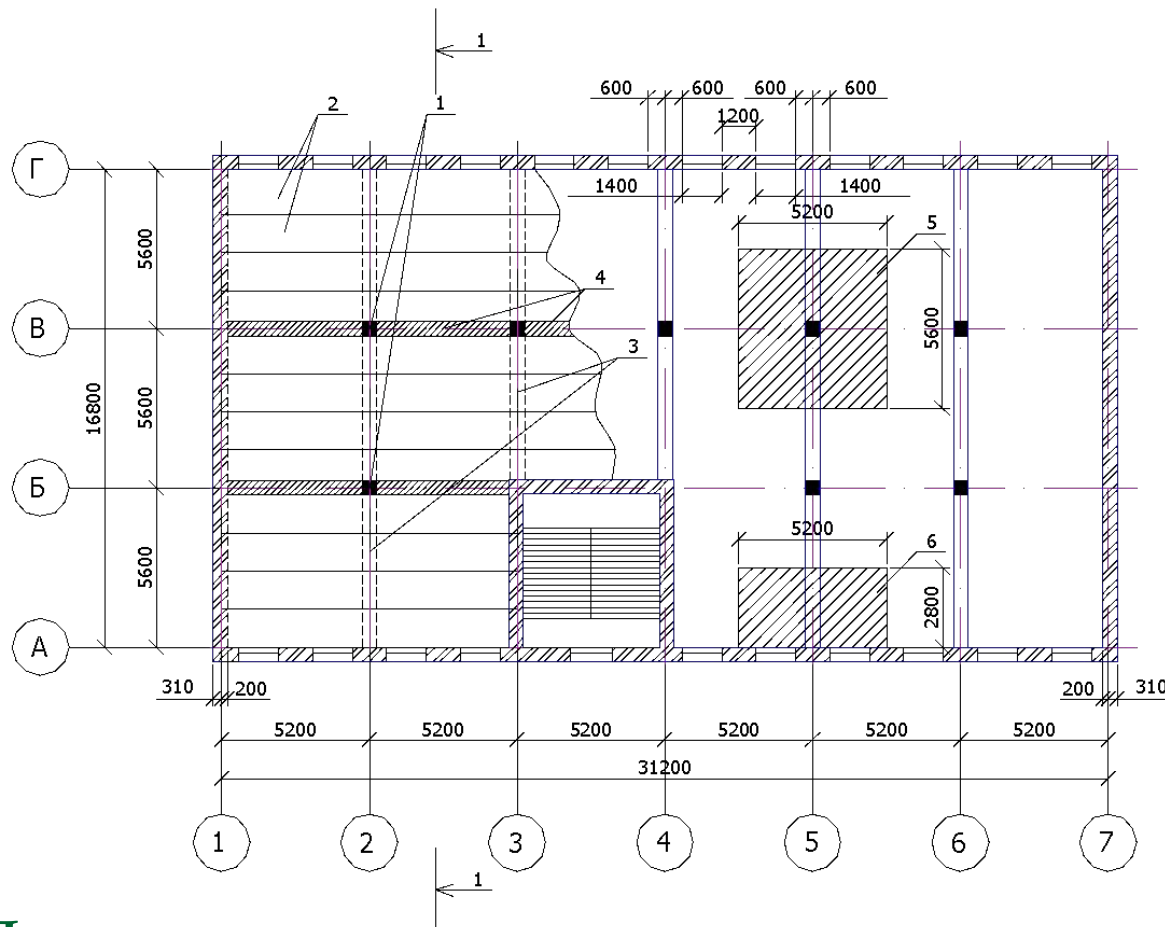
План перекрытия многоэтажного каменного здания: 1- средние опоры перекрытия – каменные столбы; 2 – плиты перекрытия; 3 – железобетонные ригели; 4 – монолитные участки перекрытия; 5 – грузовая площадь каменного столба; 6 – грузовая ощадь простенка и стены подвала
